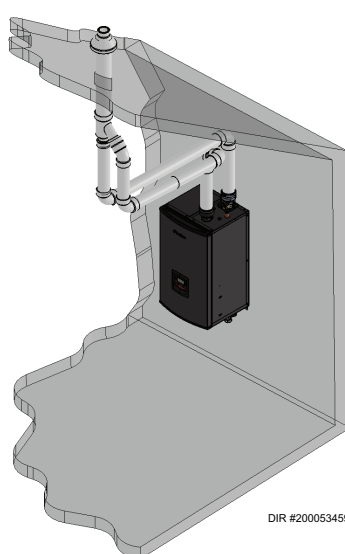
Terminaison murale concentrique en PVC/CPVC - Voir page 25 pour d'autres détails
